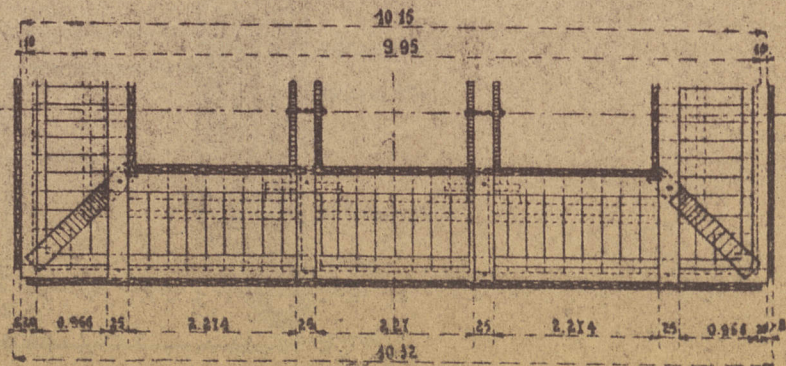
Crèche basse du pont de Rouen pendant la construction d'une pile sur caisson forcé.
